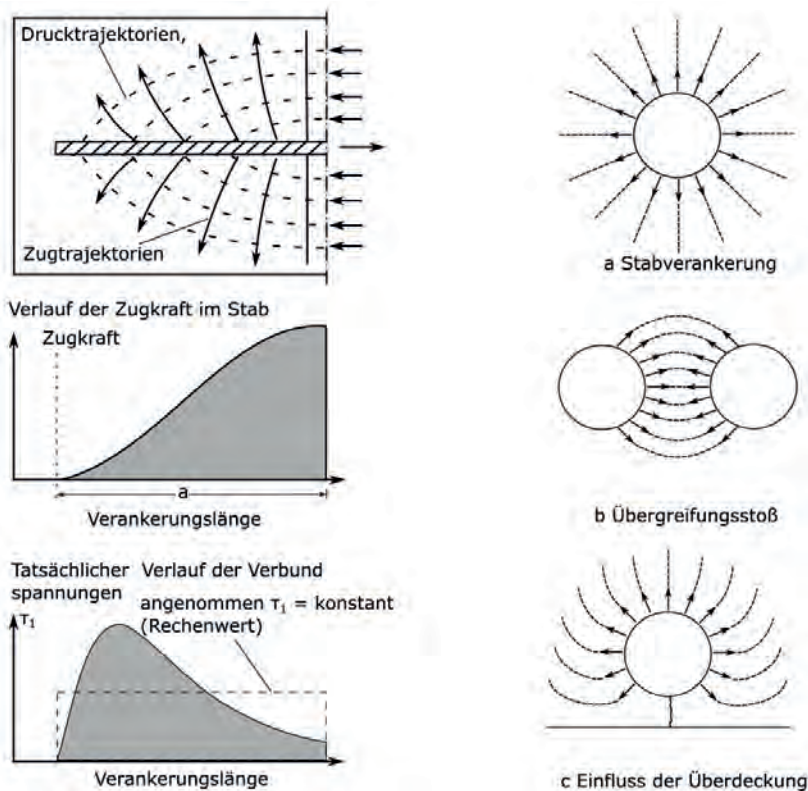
Links: Verankerung gerippter Betonstahl mit geradem Stabende nach *Leonhardt 1977
